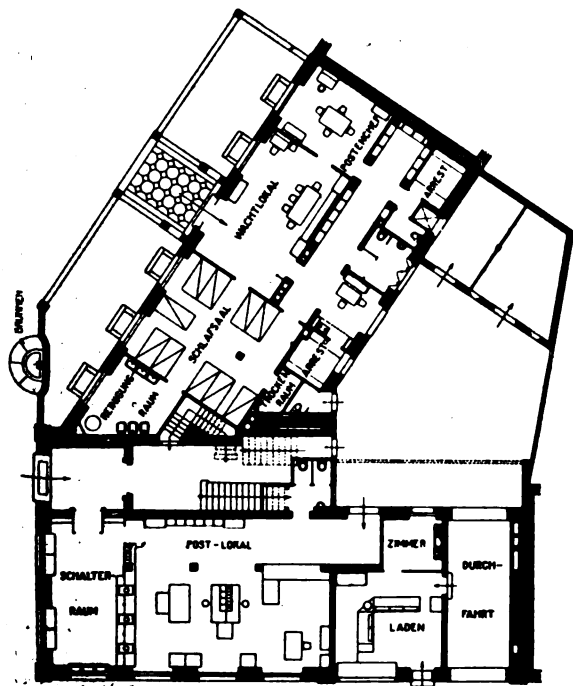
und 4. Grundrisse vom Erdgeschoss (Post und Polizei) und I. Stock (Lebensmittel-Kontrolle). — 1:400.
